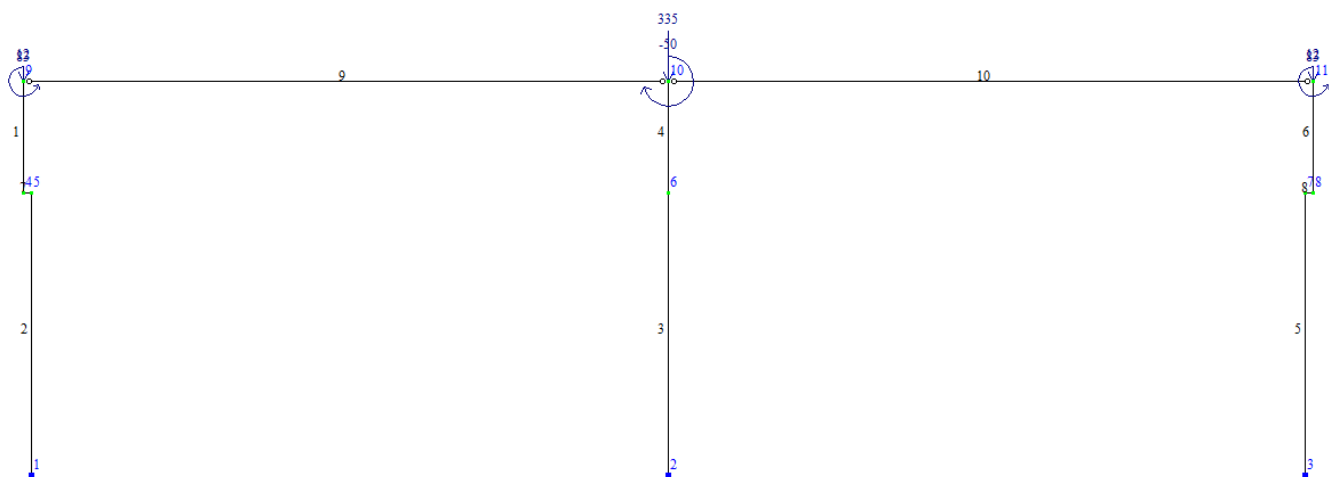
Розрахункова схема від снігового навантаження.
